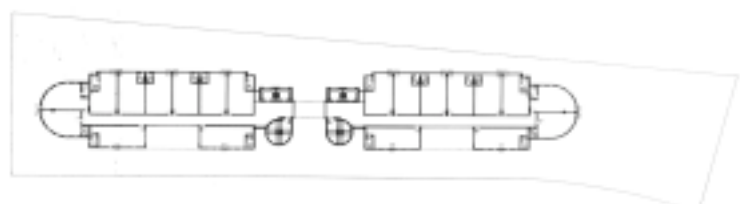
Centro Empresarial Raja Gabaglia (1989-93): planta.
